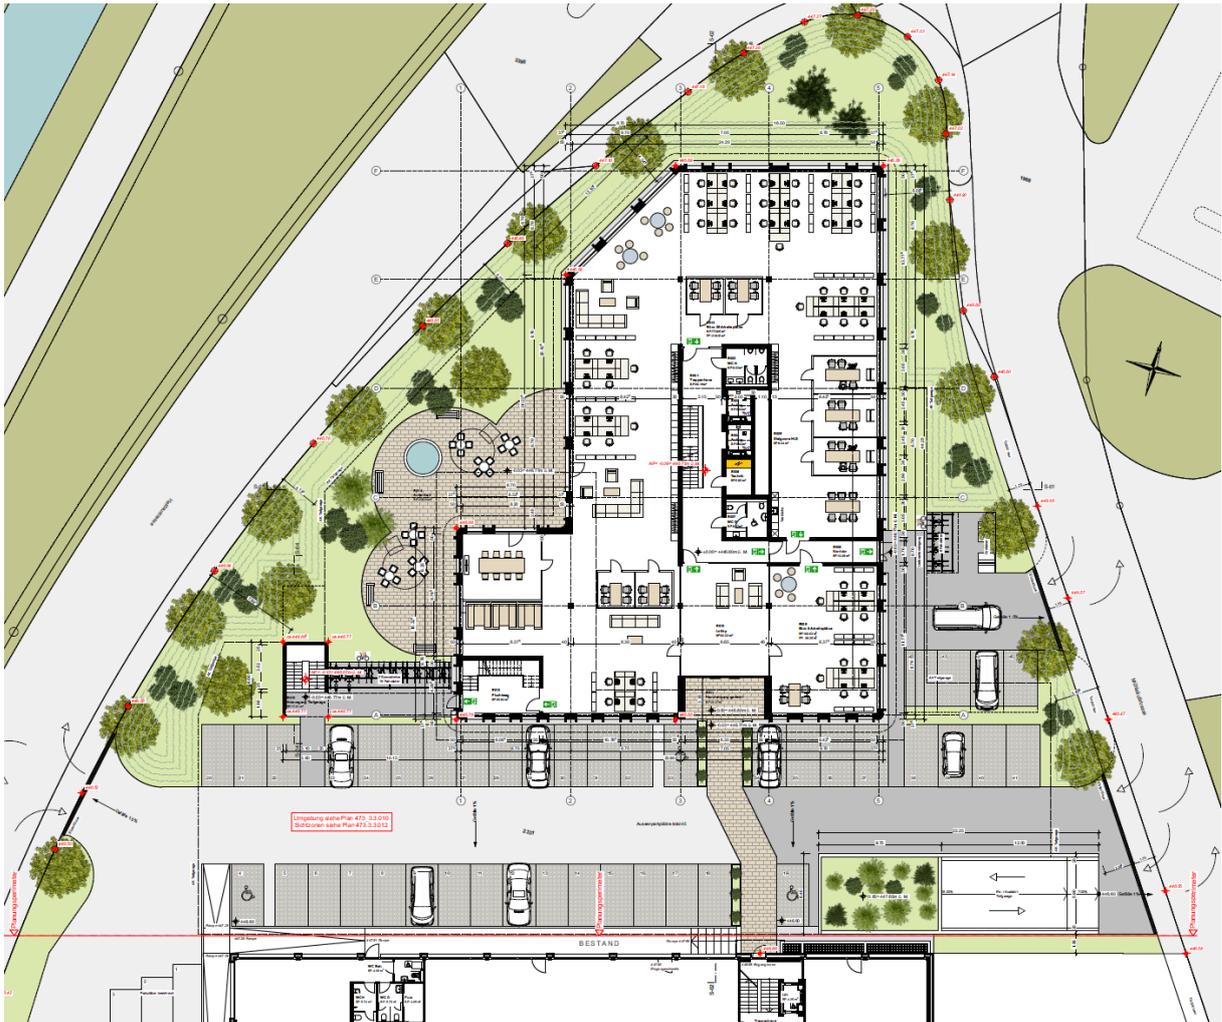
Umgebung Erdgeschoss (Quelle: FrickBau, Planunterlagen Baueingabe)
